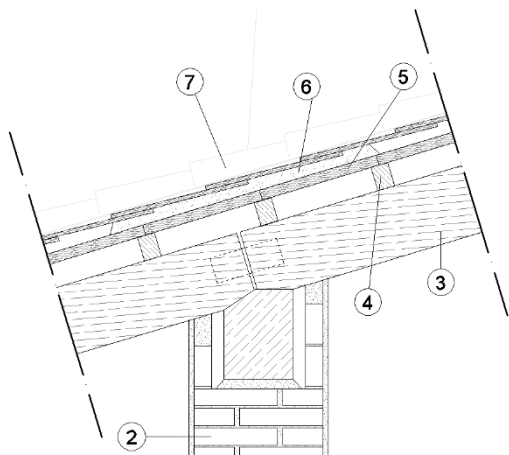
Detalle de cubierta del edificio. Fuente propia.
